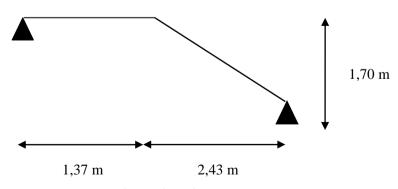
Schéma d'escalier type 1 niveau RDC et EC.
